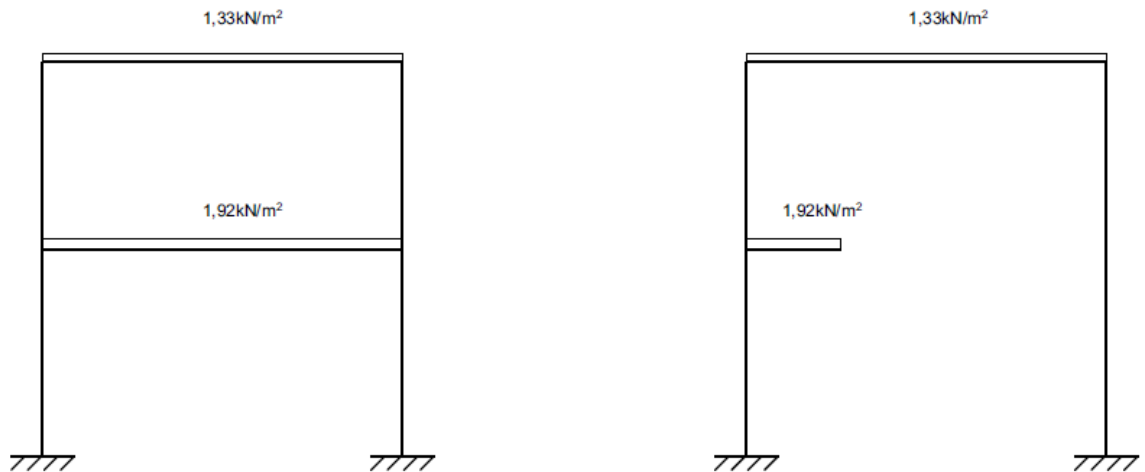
Schéma ZS1, nalevo původní stav, napravo navrhovaná úprava
